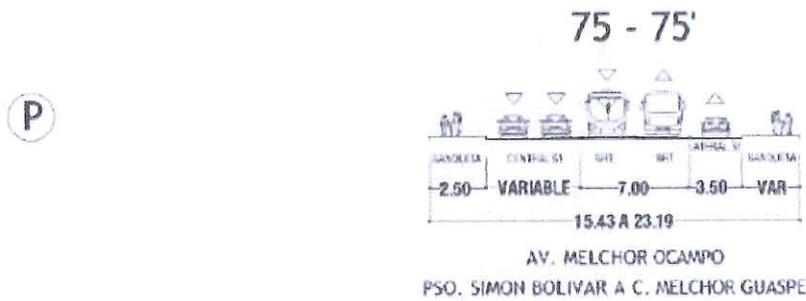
Sección vial propuesta para Avenida Melchor Ocampo Manzo. Fuente PDU 2040.
